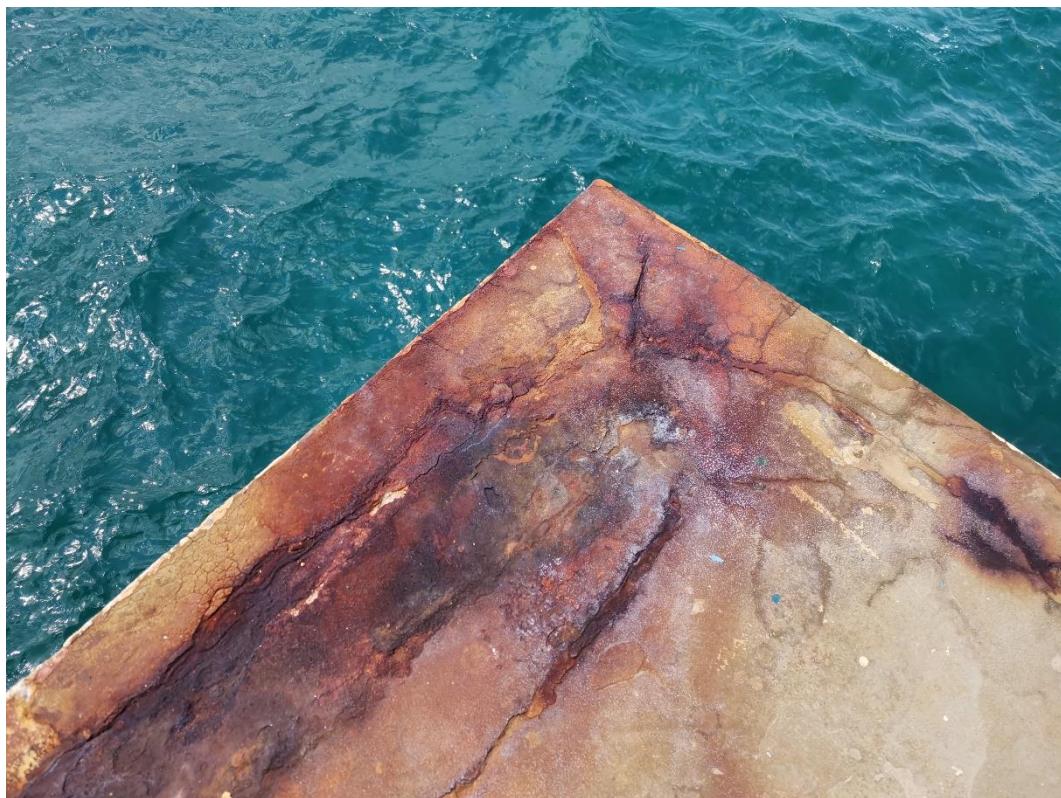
Podest br. 3; odlamanja betona na rubovima ploče, ljuštenje i promjena boje betona
